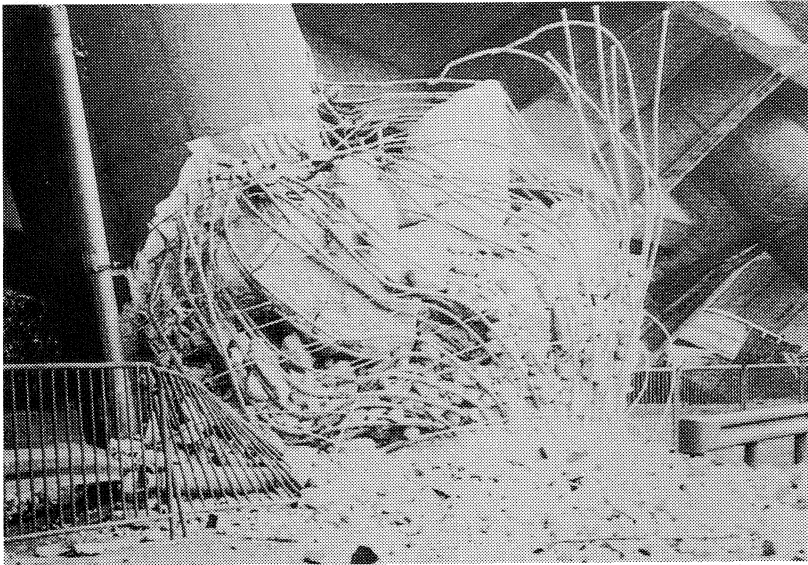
阪神高速道路 高速神戸線 ピルツ橋の橋脚
